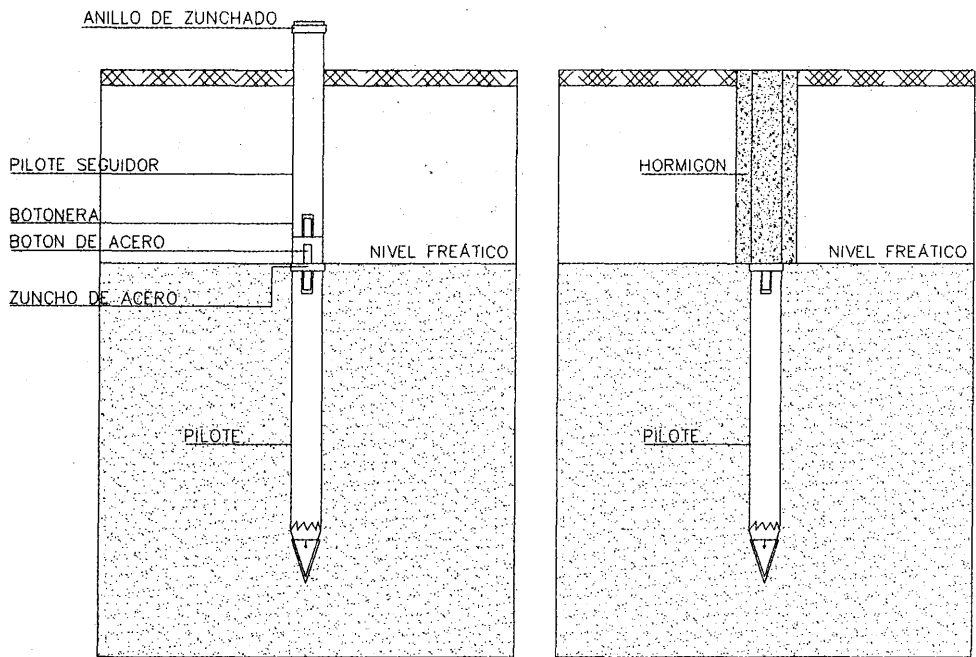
Cimentación profunda realizada mediante pilotes de madera.
